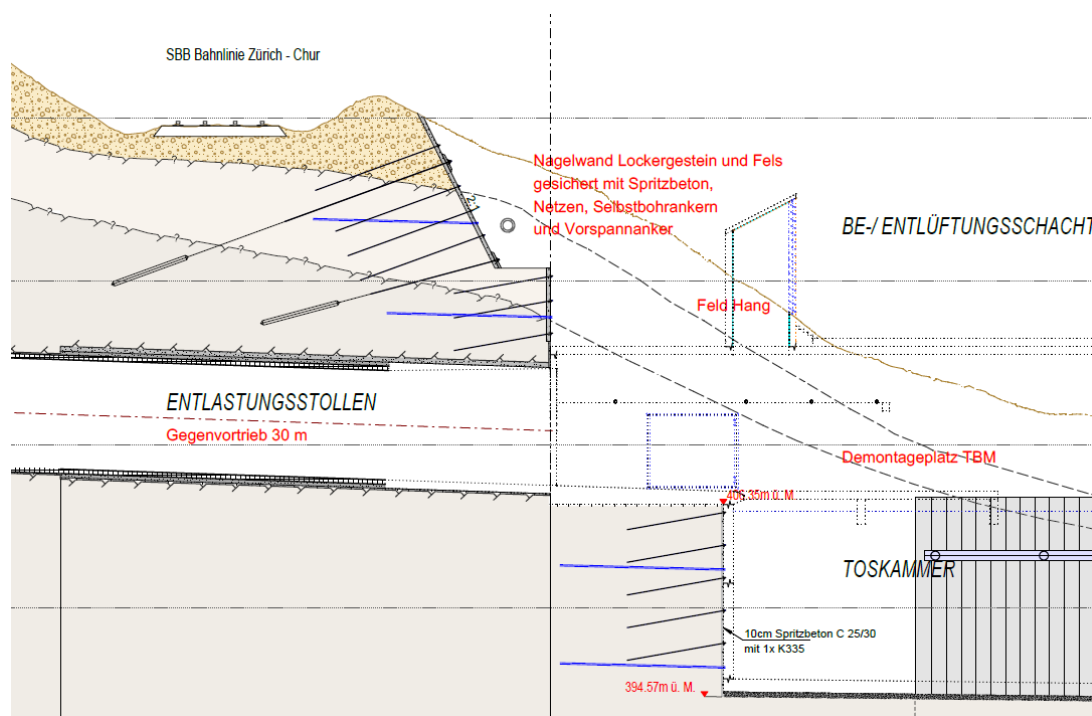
Voreinschnitt Abschnitt Hang (Bauzustand 3)
